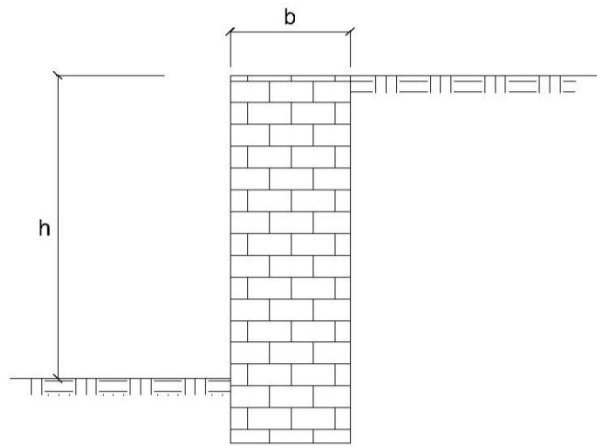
Exemplos de muros. (MARCHETTI, 2007)
